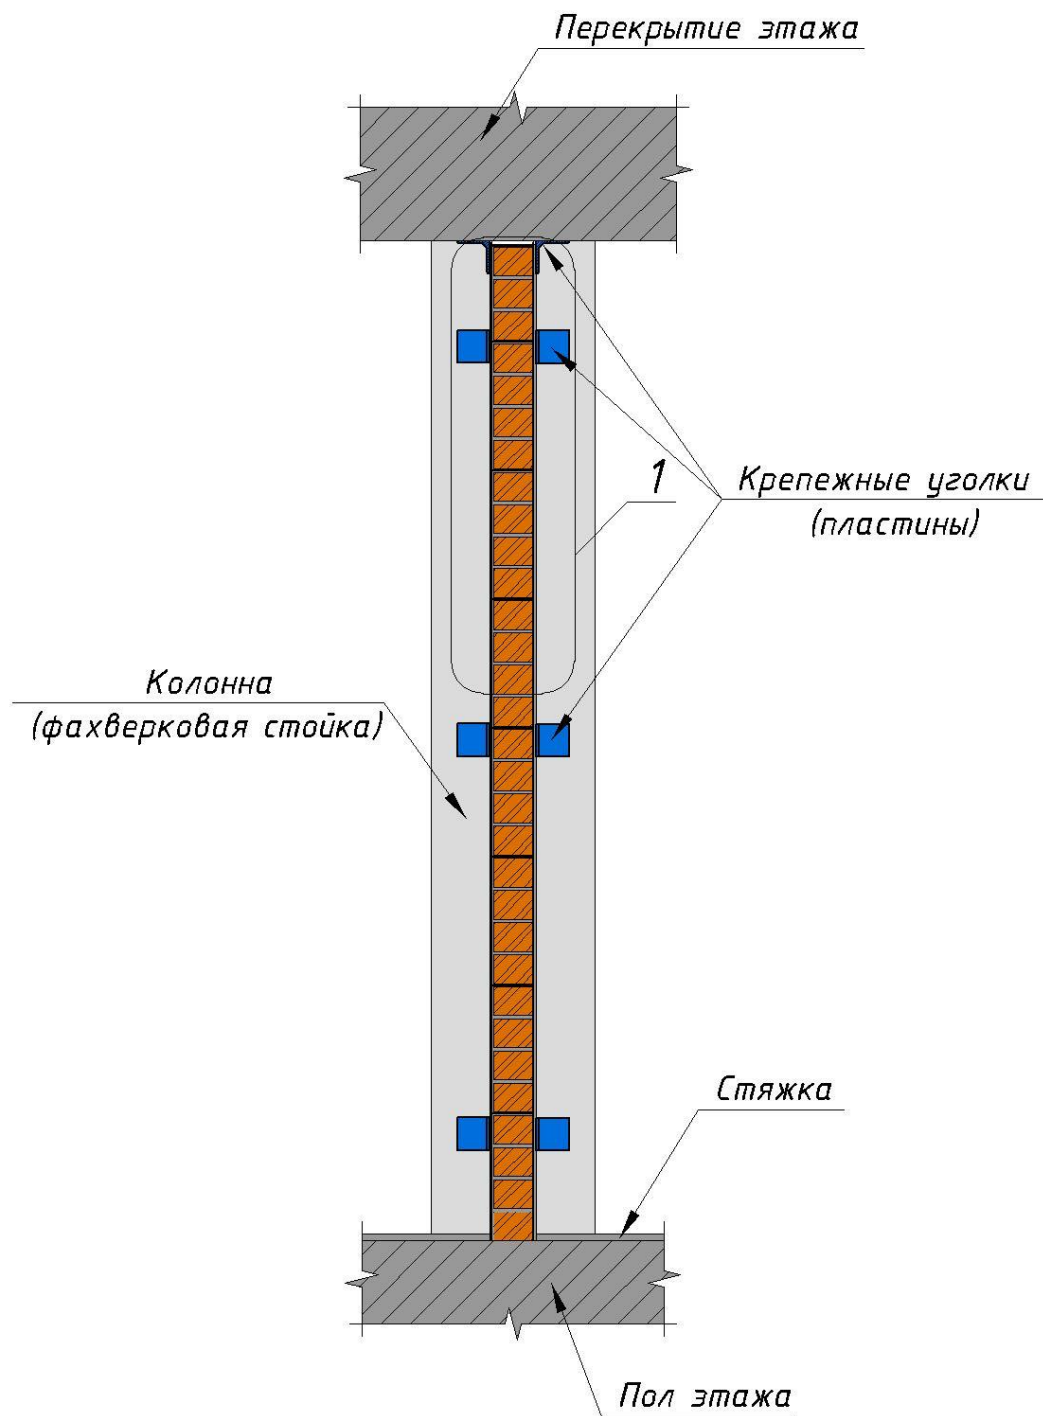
Схема крепления перегородки из кирпича, усиленной вертикальным армированием с помощью базальтовой сетки, к каркасу здания
